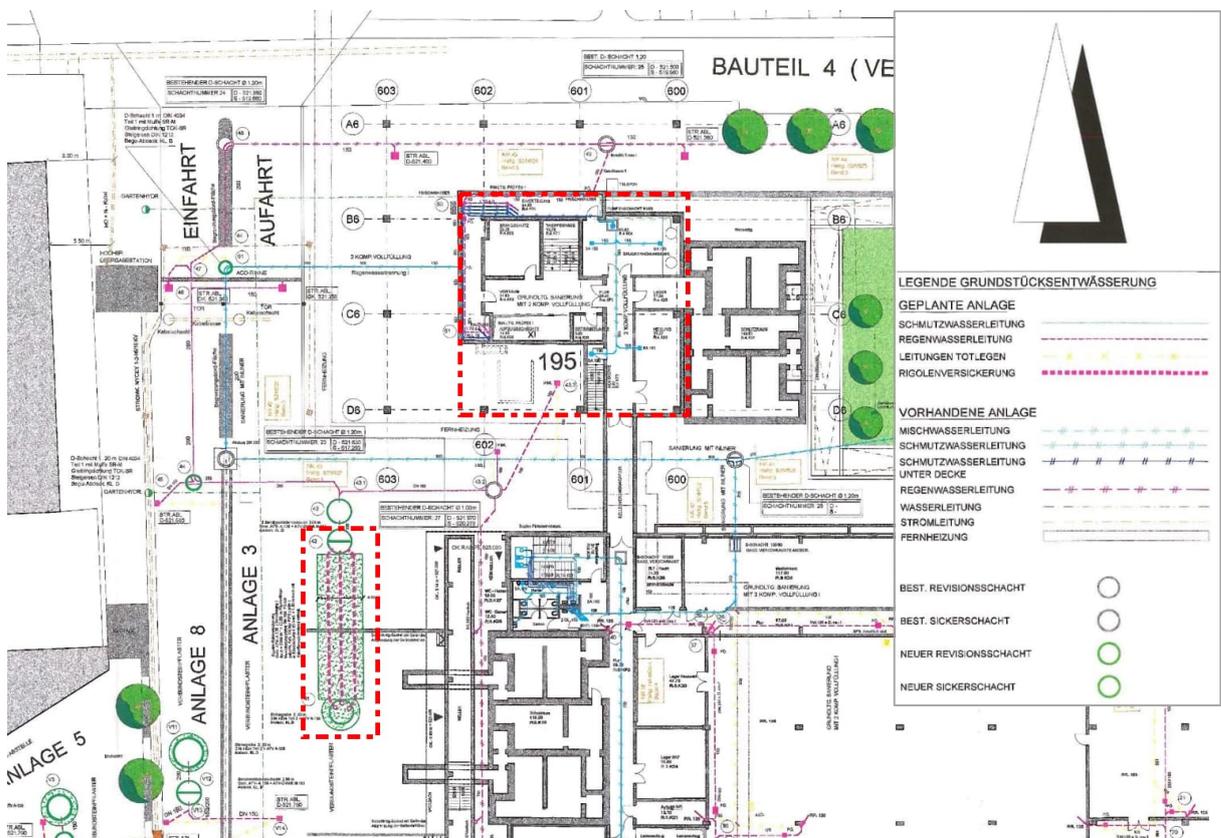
Ausschnitt Lageplan Entwässerung Postturm, verändert (Ingenieurbüro Geiger, 2002)
